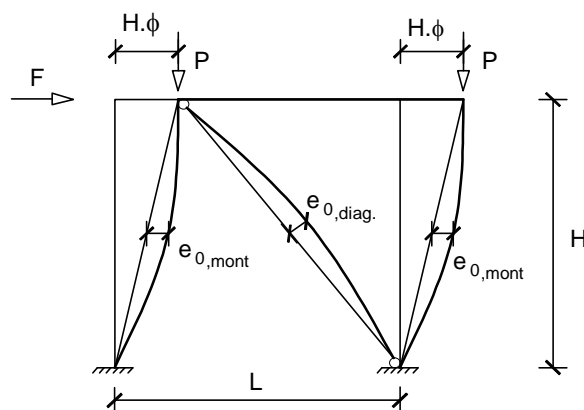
Pórtico genérico e respectivo carregamento.
